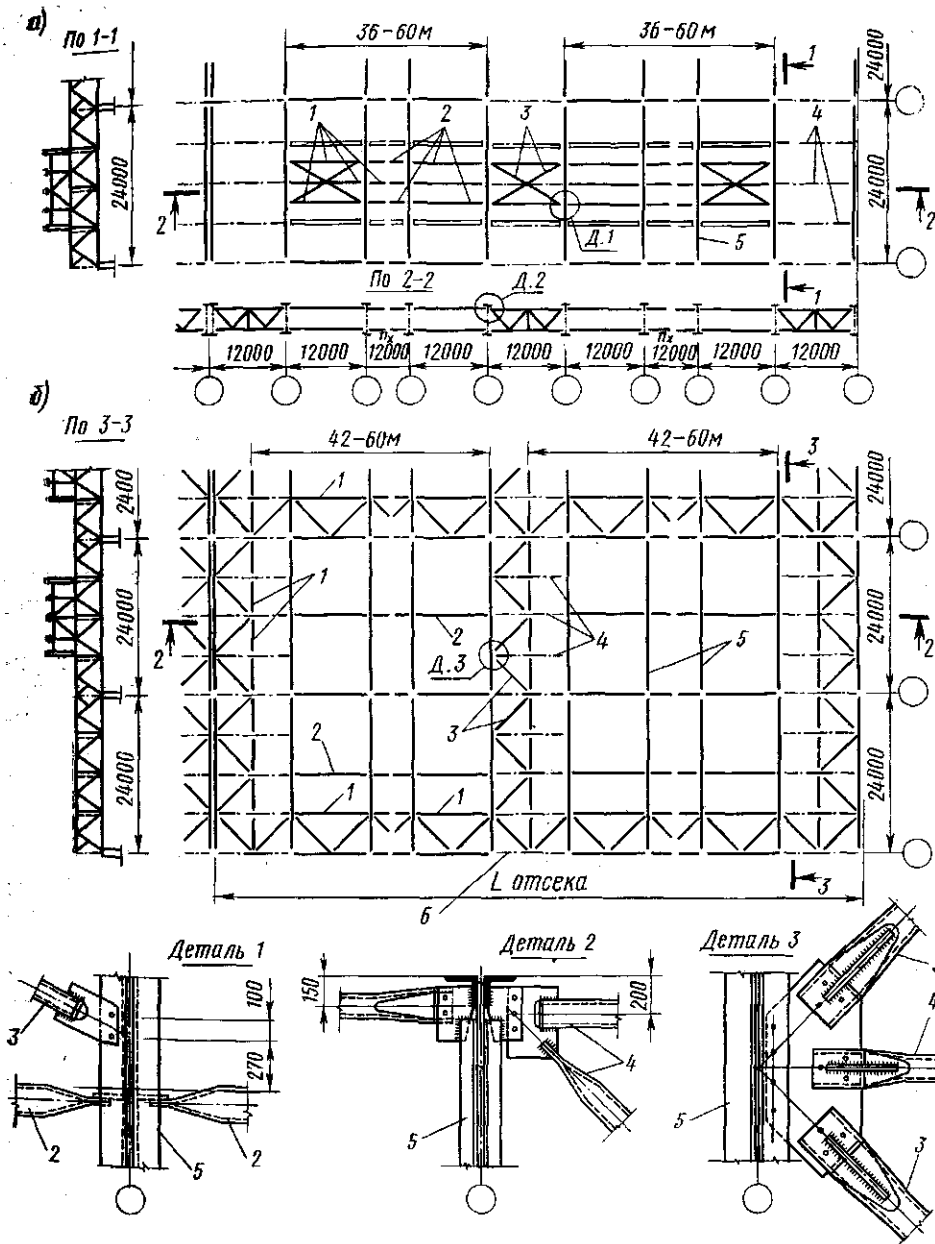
Пример решения связей в покрытии со стальными фермами: а — по верхним поясам стропильных ферм; б — то же, нижним; 1 — распорки; 2 — растяжки; 3 — раскосы; 4 — вертикальные связи; 5 — стропильные фермы; 6 — связывающие фермы
